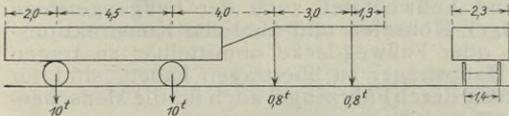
und 69. Lastschema für Landstraßen-Brücken.
